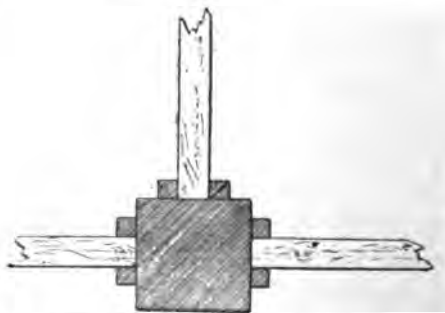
Détail d'un assemblage des caissons sur un plateau.
